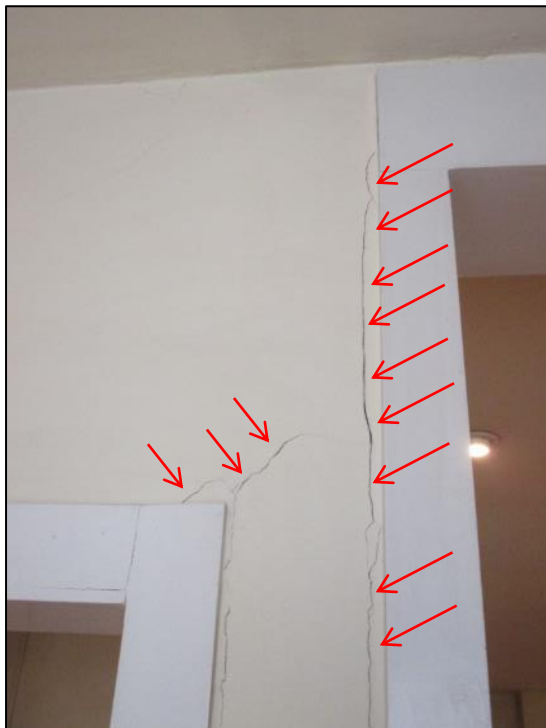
Fisuras en enyesado pared paralela a fachada.
